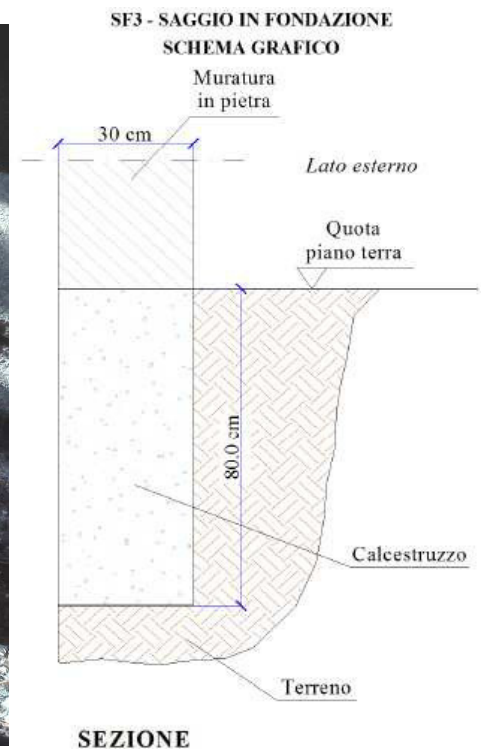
Indagine SF3 (saggio in fondazione) del Blocco C: è stata rilevata una fondazione in cls di altezza pari a 80 cm.
